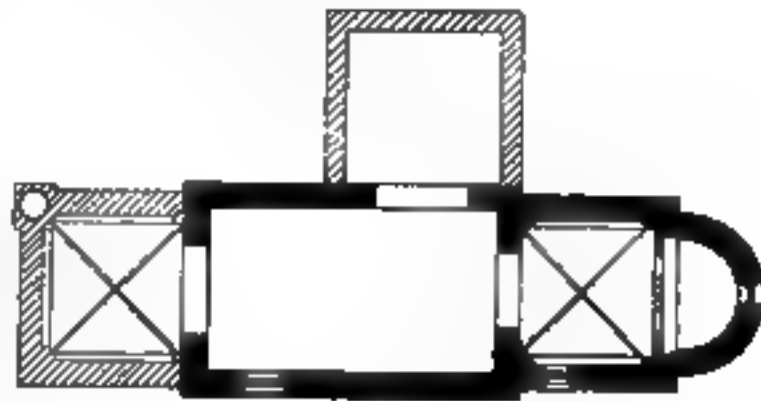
Grundriss der Kirche zu Aller.
